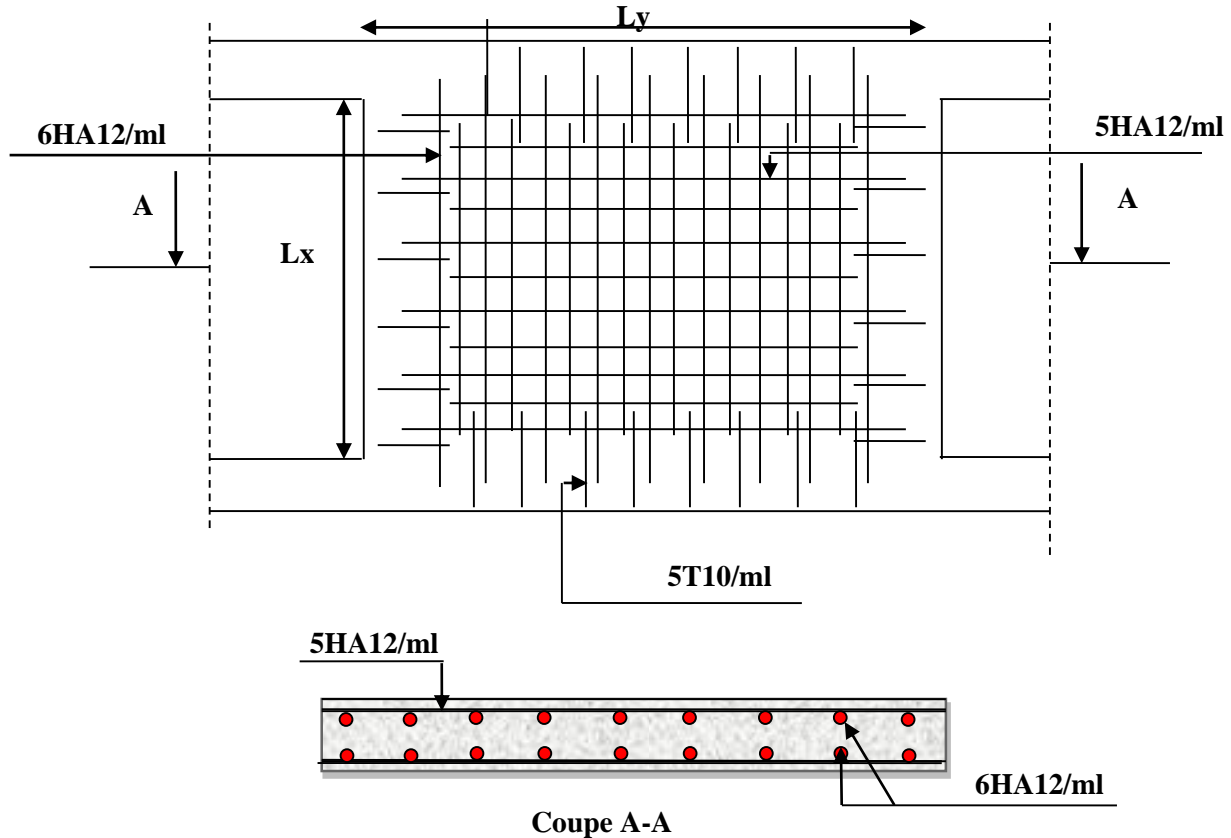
Schéma de ferrailage de mur de soutènement.
